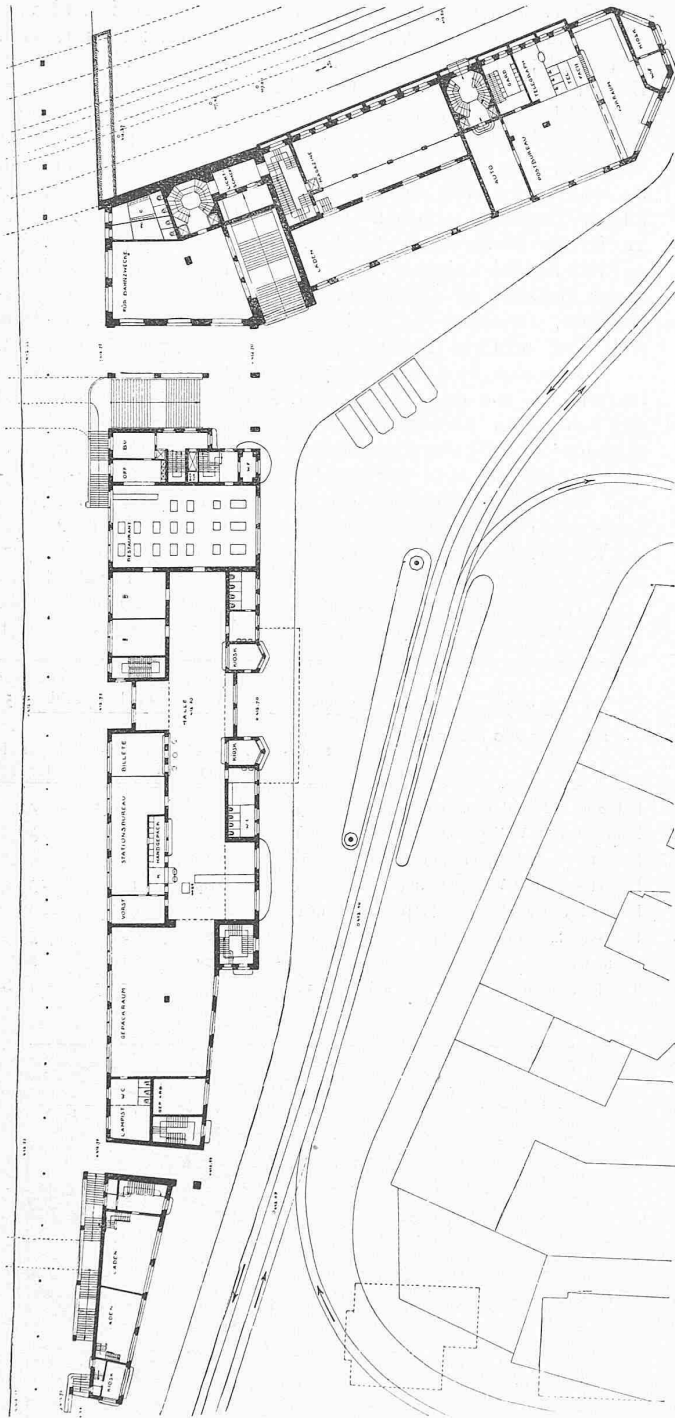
Erdgeschoss-Grundriss mit Bahnhofplatz, Masstab 1 : 800.
